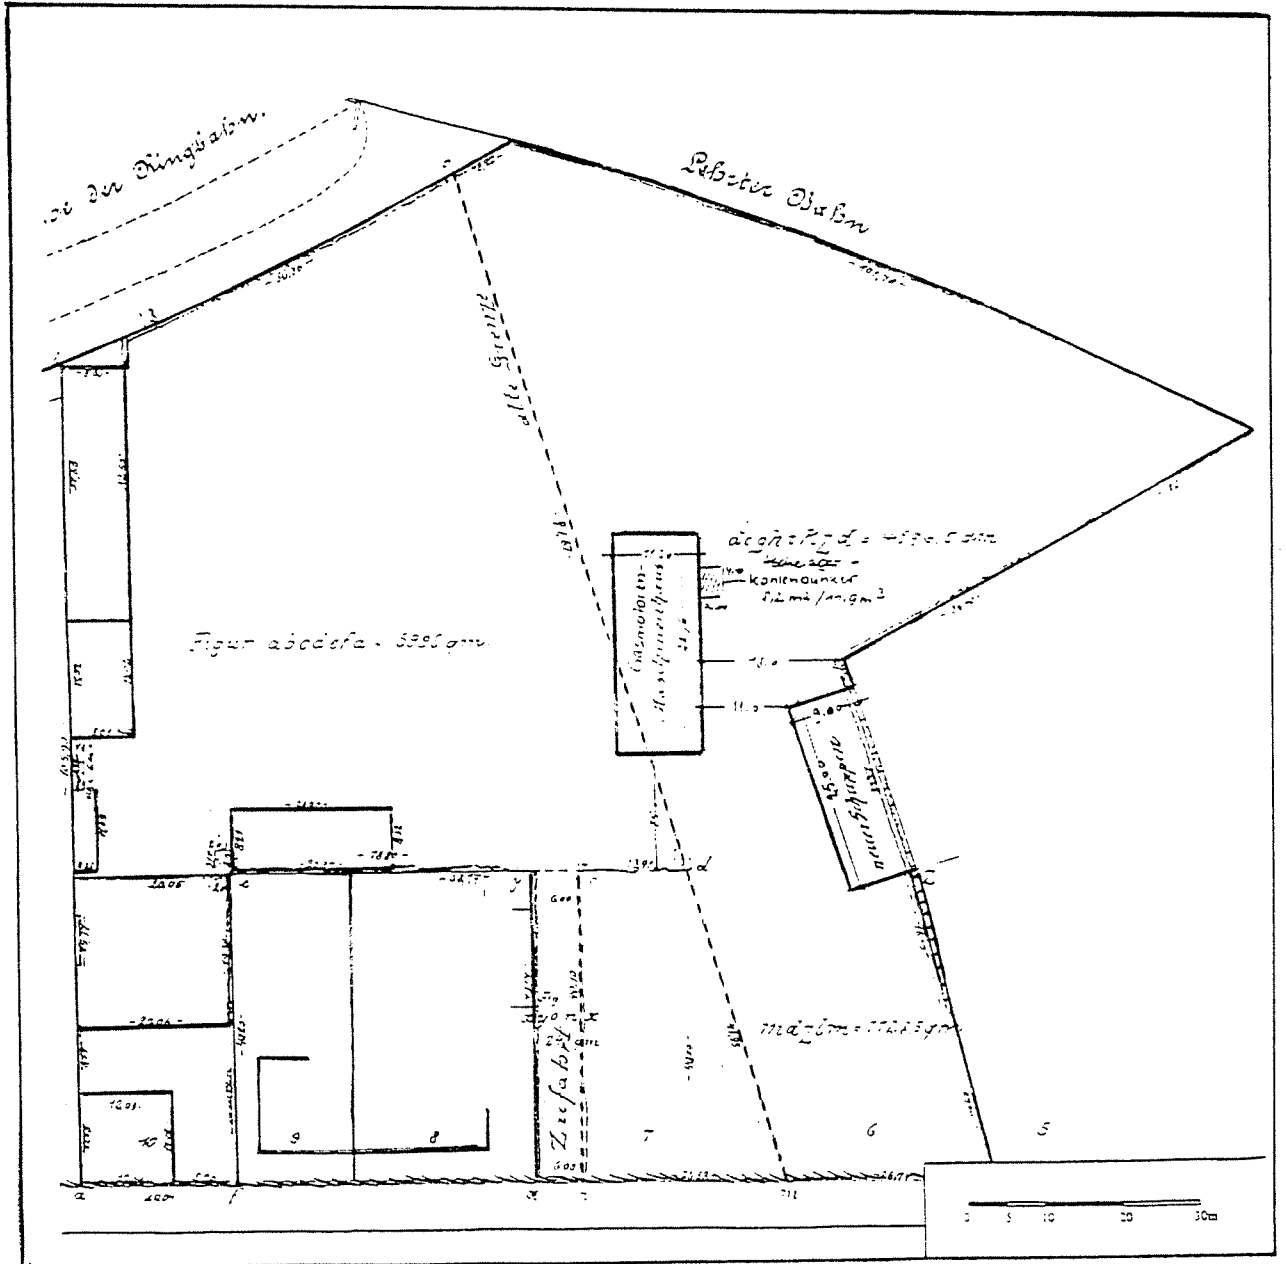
b : Verdachtsfläche 3 - Bebauungssituation 1897
